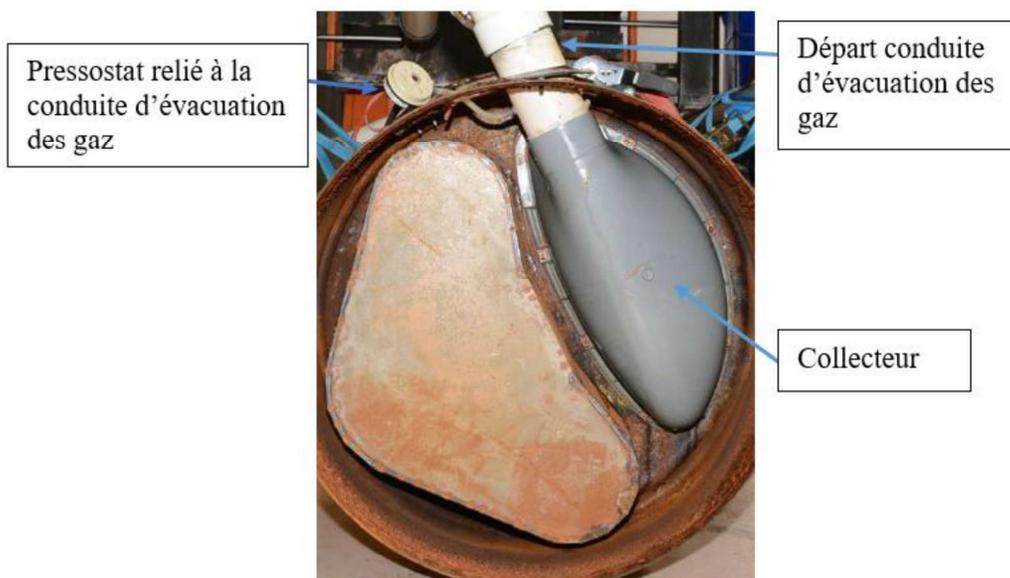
Photo du collecteur et de la conduite d'évacuation sous le chauffe-eau 84
